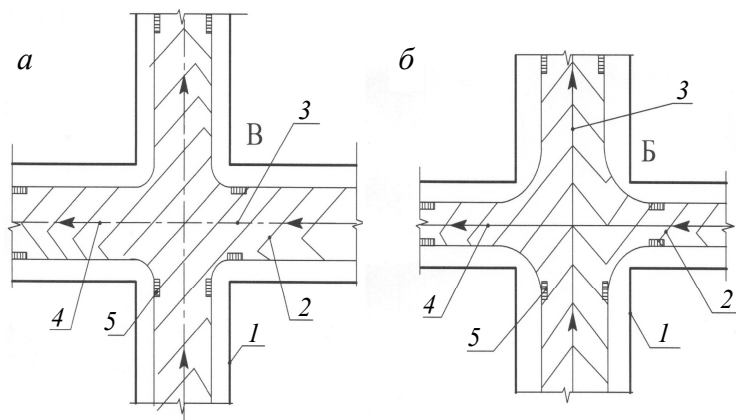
Вертикальная планировка перекрестка, расположенного на холме (применительно к перекресткам Б и В (см. рис. 8)):
